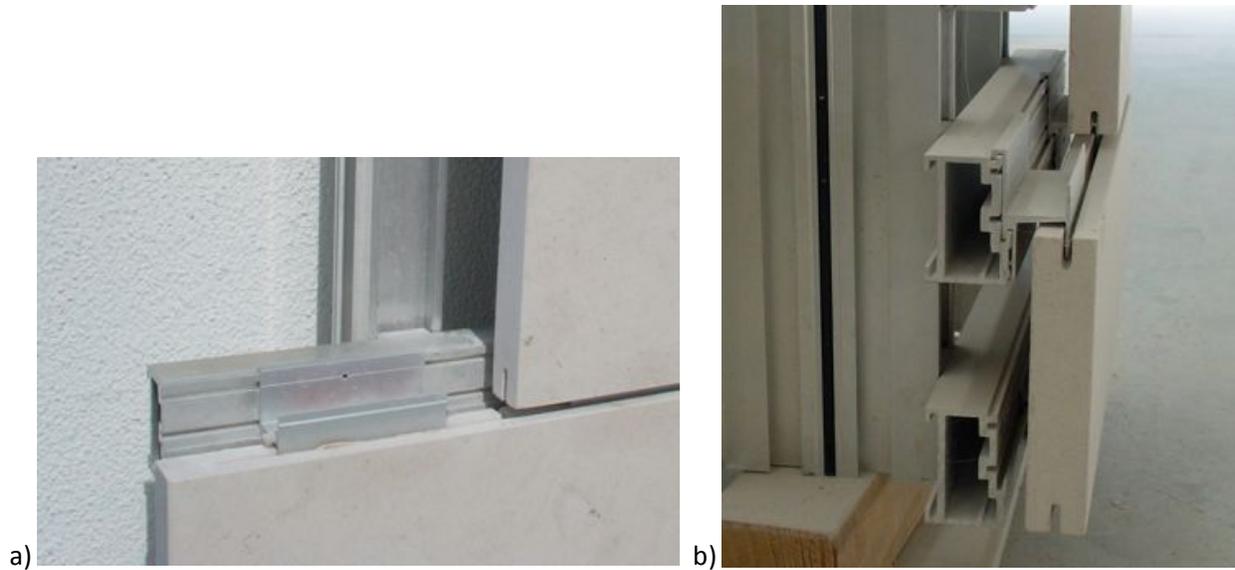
Detalhe de uma fachada com estrutura intermédia de suporte onde se observa um clips de seguimento para fixar a placa de pedra e as calhas nas pedras: a) vista frontal b) lateral
